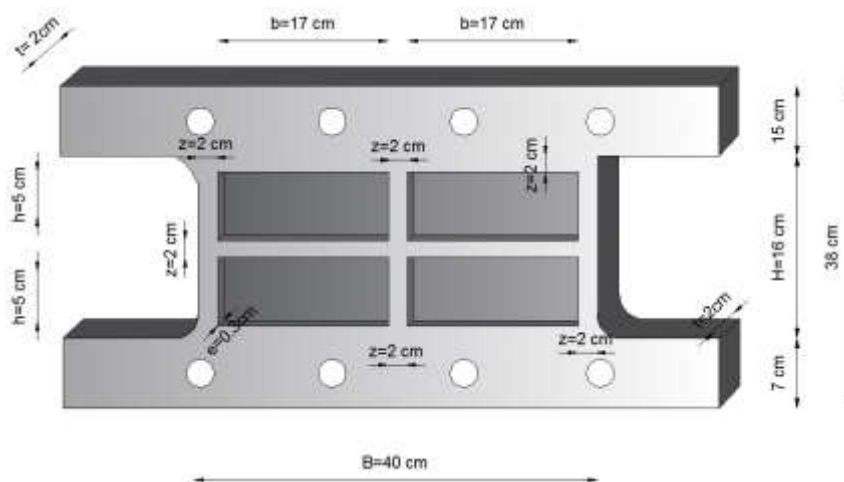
Disipador SLB utilizado en el Proyecto Fuerzas Armadas ESPE
